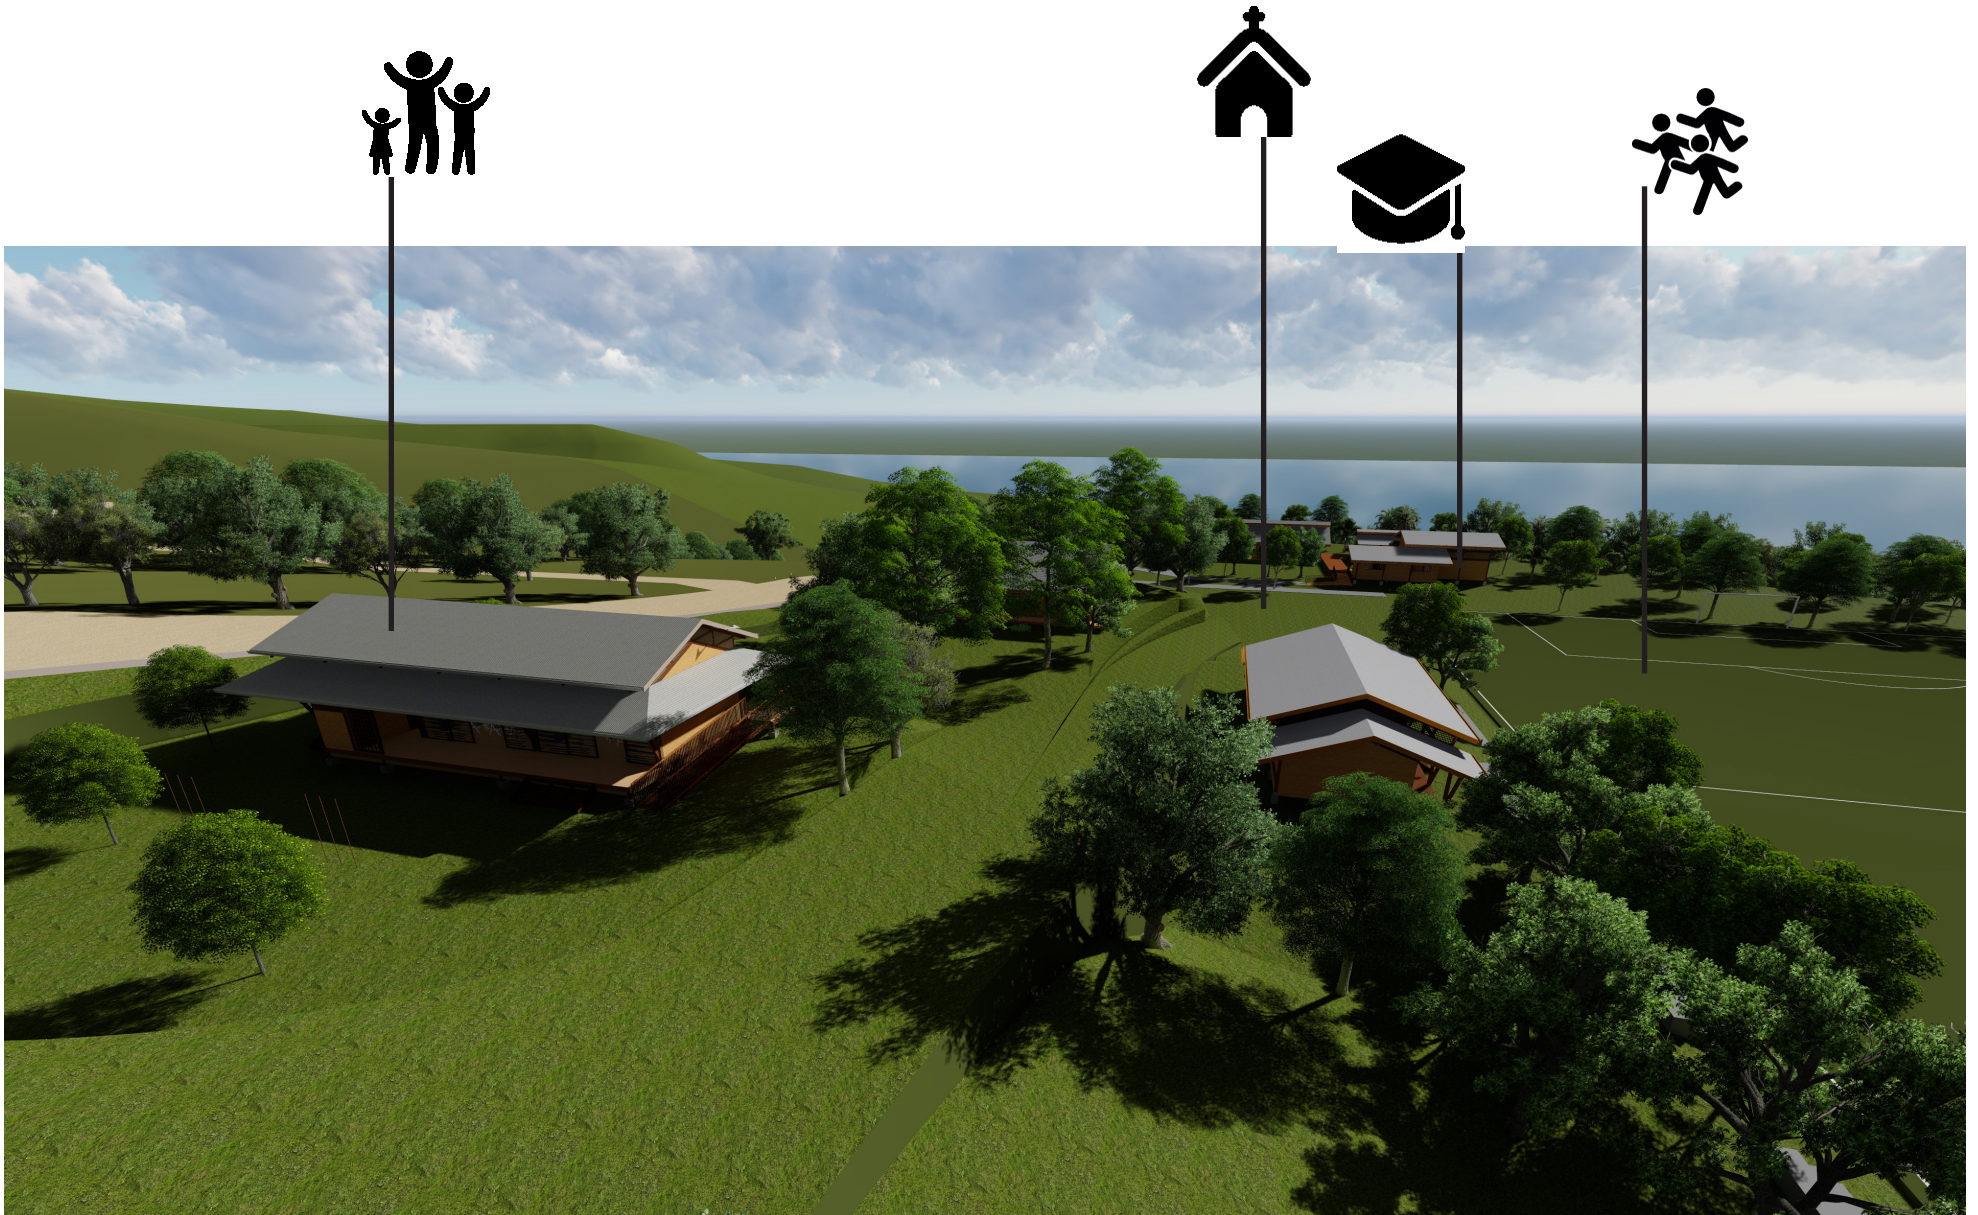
17. Vista 3D de la propuesta de asentamiento. Elaboración propia.
